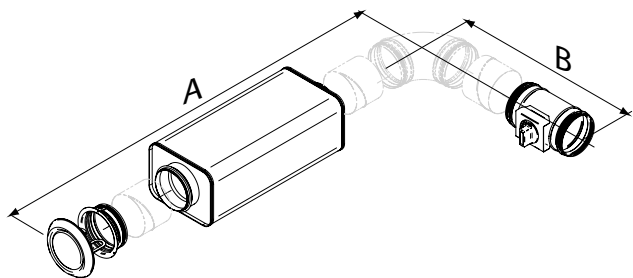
Tilluftkit PARAGON T-SAK-VAV-100
